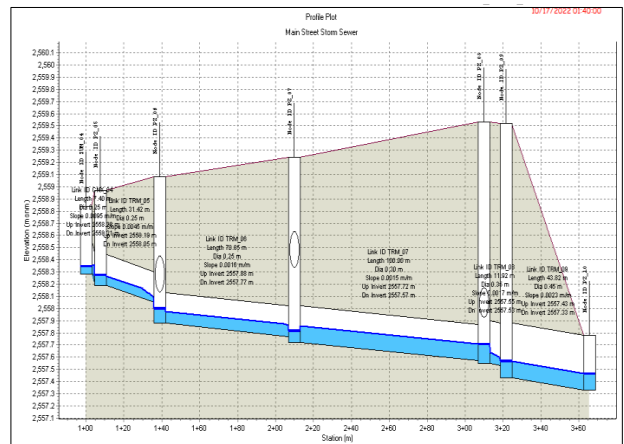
Perfil del sistema de drenaje de la calzada oriental. Sistema tradicional con SUDS.
